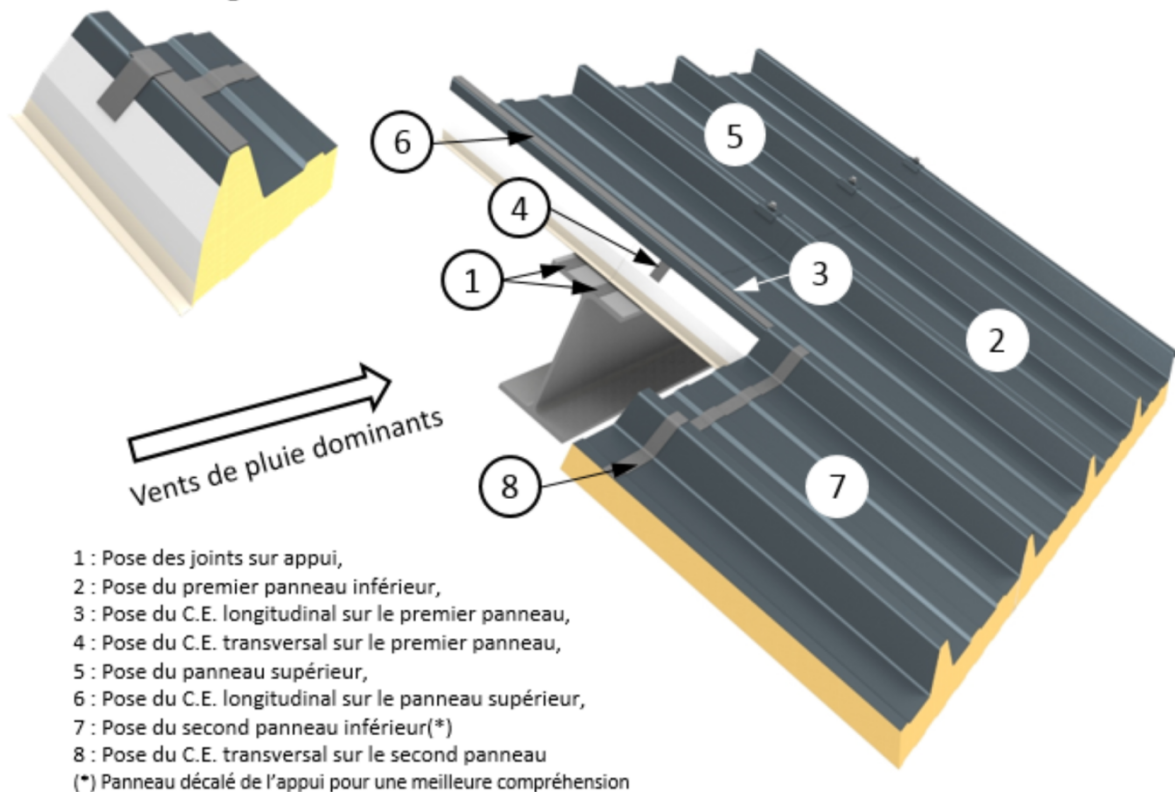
Détail sur appui – Joints sur appui au droit d'un recouvrement transversal de panneaux avec Complément d'Etanchéité (C.E.) transversal et longitudinal - locaux à faible ou moyenne hygrométrie (cf. §2.4.4)
